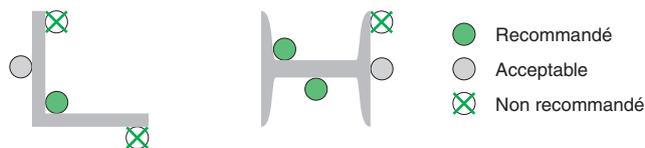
Recommandation pour l'installation de câbles sur poutrelles métalliques
